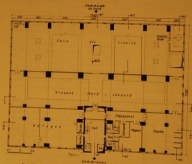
Vue du plan du bâtiment de la rue Cassini et de la tour.
